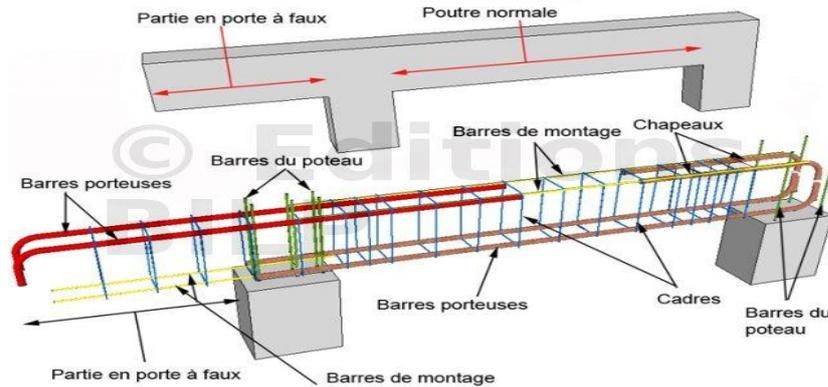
schema explicatif sur poteaux source: prêcheur 2019
